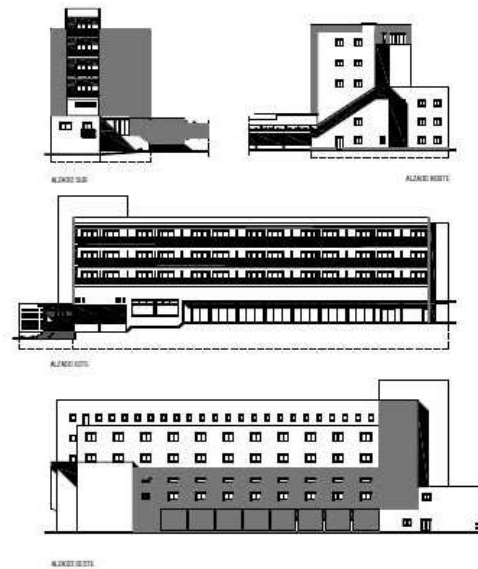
Panel hotel Bayren. Fuente: elaboración propia
